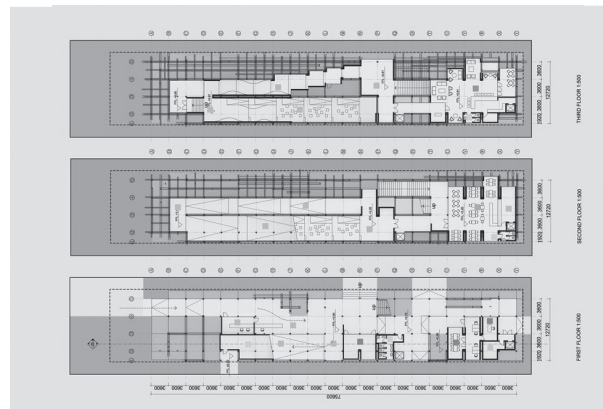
Plantas baixas do projeto para concurso de Penda Architects
